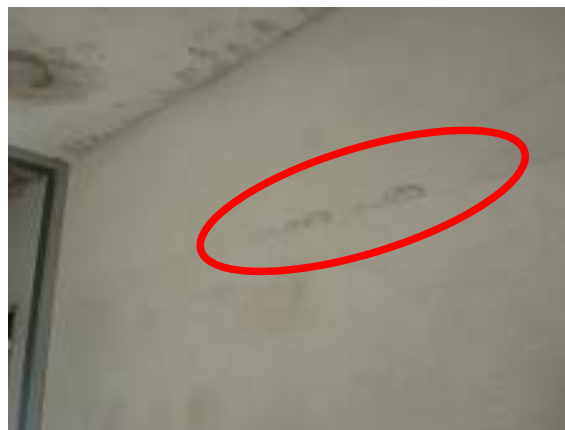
aparecimento de fissura no encunhamento com problemas de infiltração (dia de sol)
